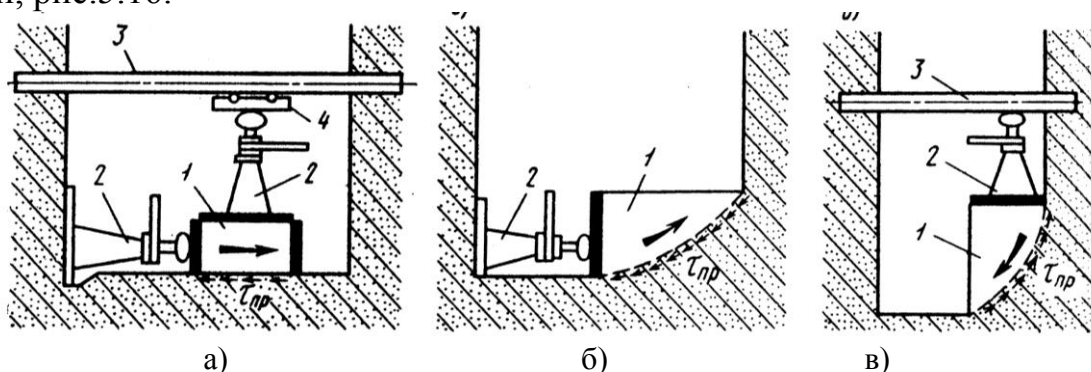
Схема испытания целиков грунта в шурфах: 1 – целик грунта; 2 – домкраты; 3 – упорная балка; 4 – каретка для перемещения головки домкрата
